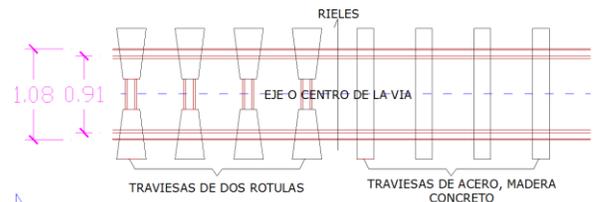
Detalle de traviesas de dos rótulas y detalle de traviesas sólidas acero, madera y concreto. (Fuente: Autor)
